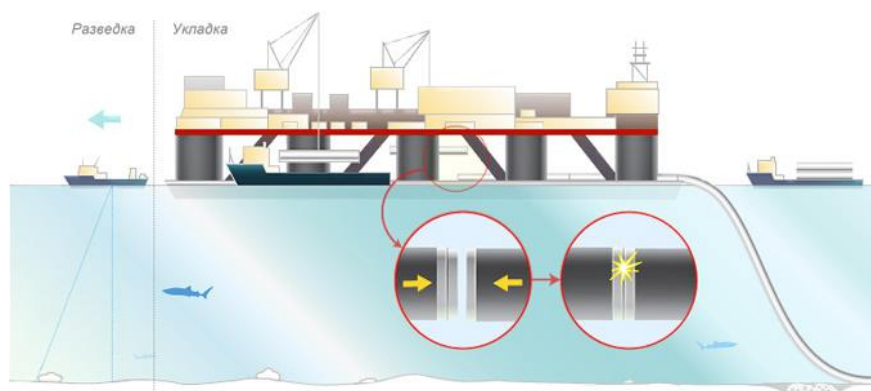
Схема укладки трубопровода при помощи судов-трубоукладчиков
